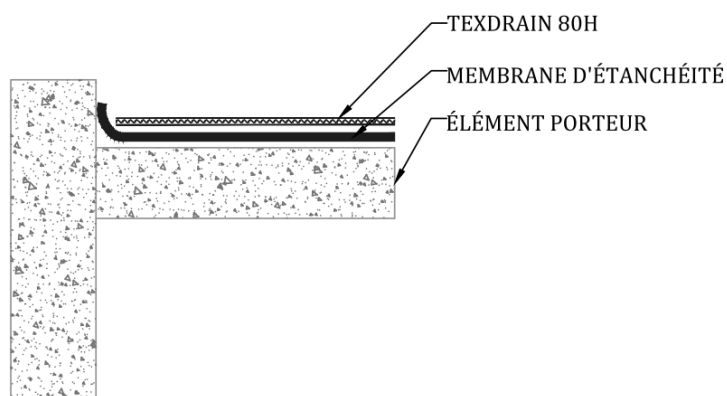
Coupe type de la mise en place du TEXDRAIN 80H, application pour les toitures
